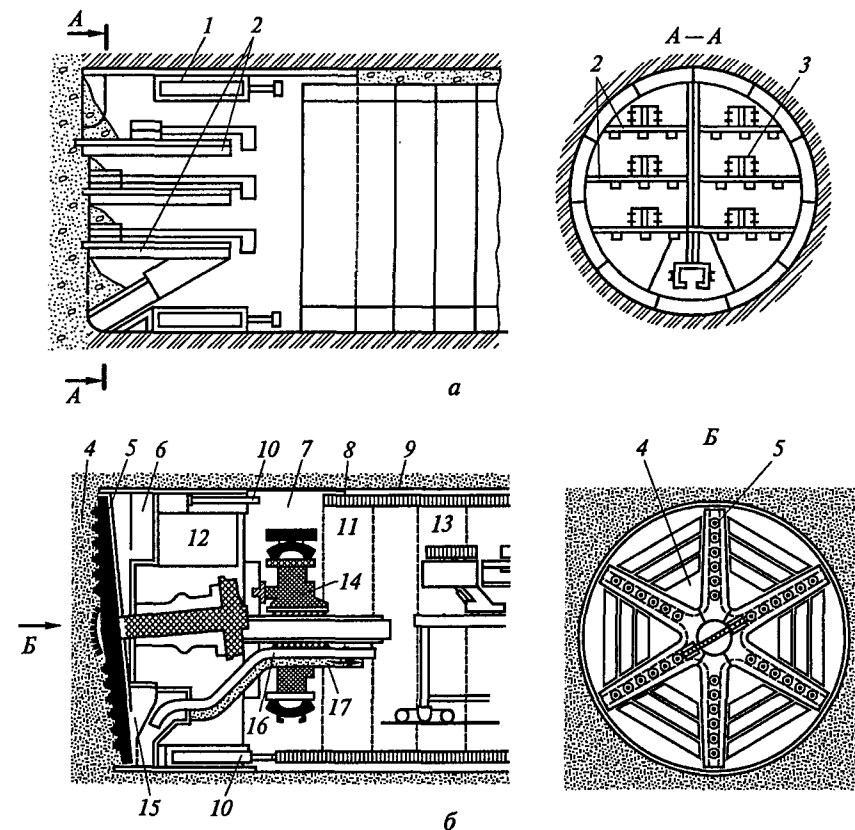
Схемы механизированных щитов для неустойчивых сухих (а) и водоносных (б) грунтов:
